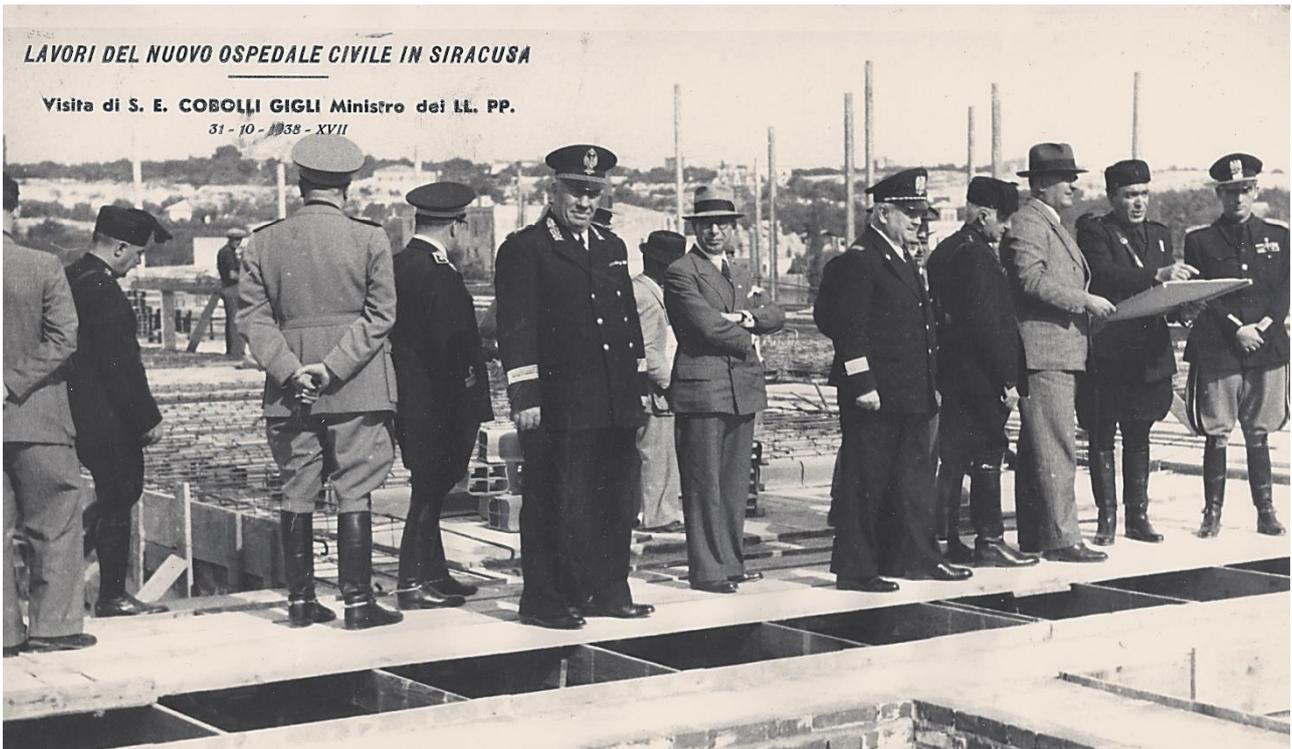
Visita del Ministro Cobolli Gigli al cantiere dell'ospedale, 1938.
